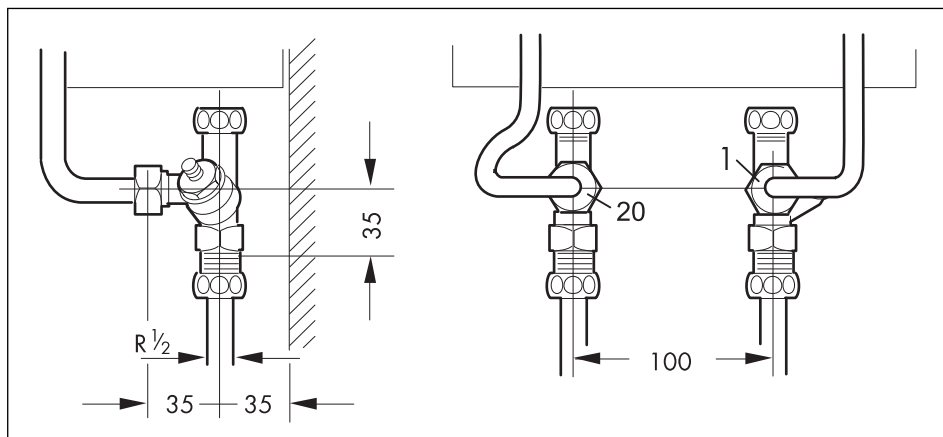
Открытый монтаж, подключение холодной воды к напорной арматуре; Размеры в мм
